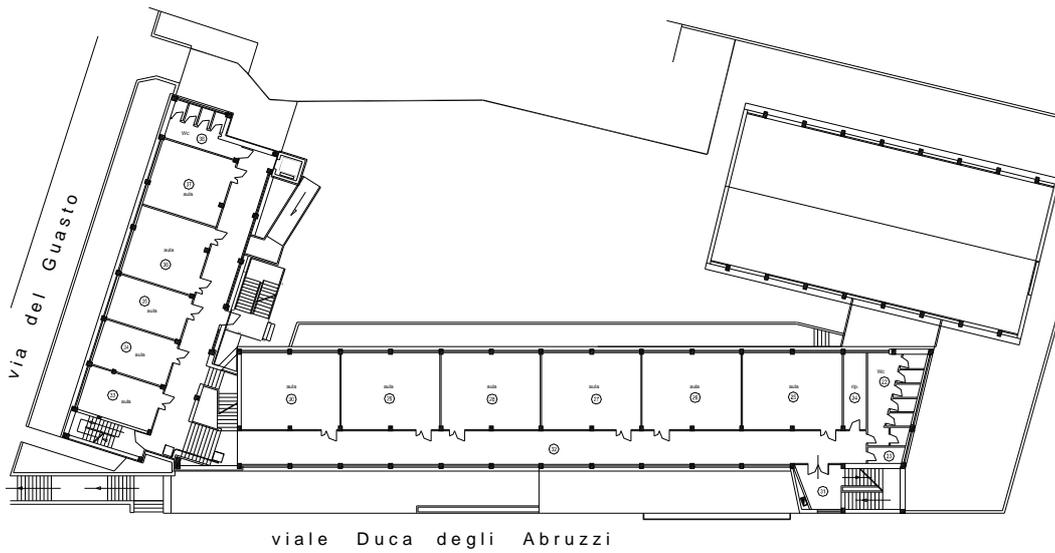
Pianta Piano Primo (aule scolastiche).
